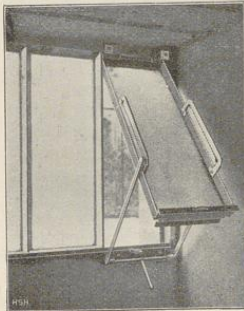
Innenansicht eines Kellerfensters mit Lüftungsflügel.
